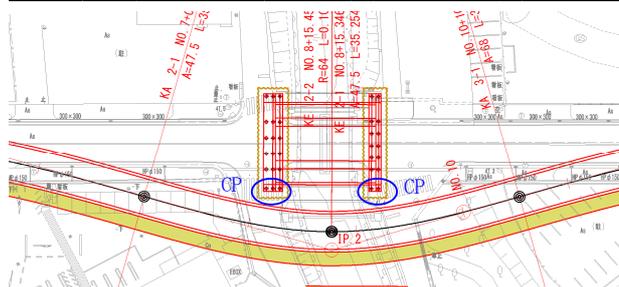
迂回路平面図(第1案：一括施工上流側迂回路案)
